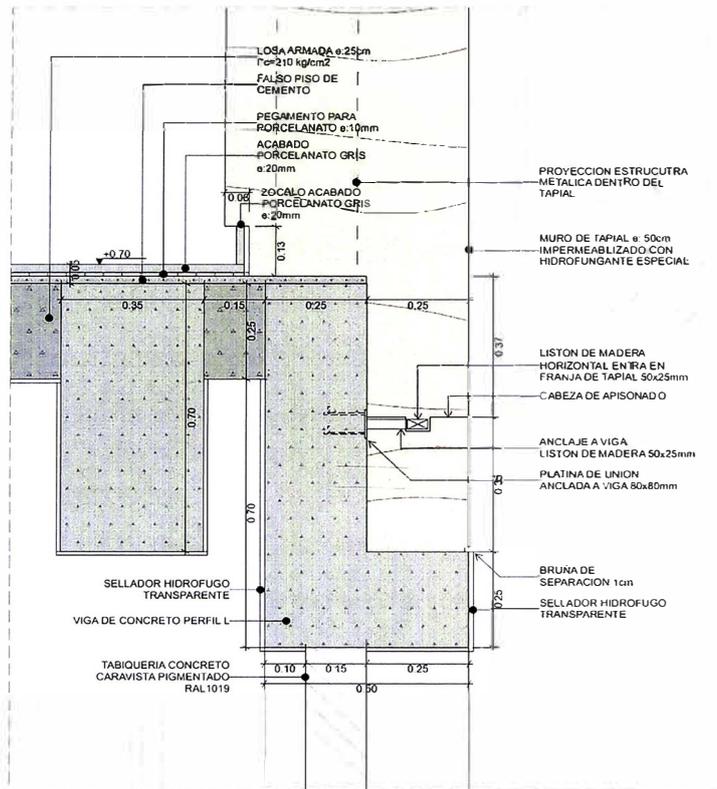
Corte constructivo empalme de tapial a viga de concreto.
